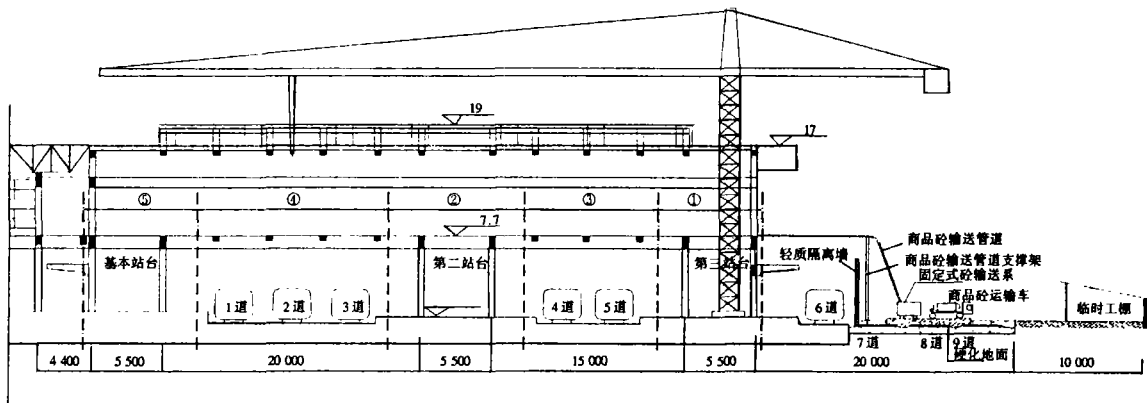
福州火车站站房改造高架候车室工程施工立面及施工顺序示意图
